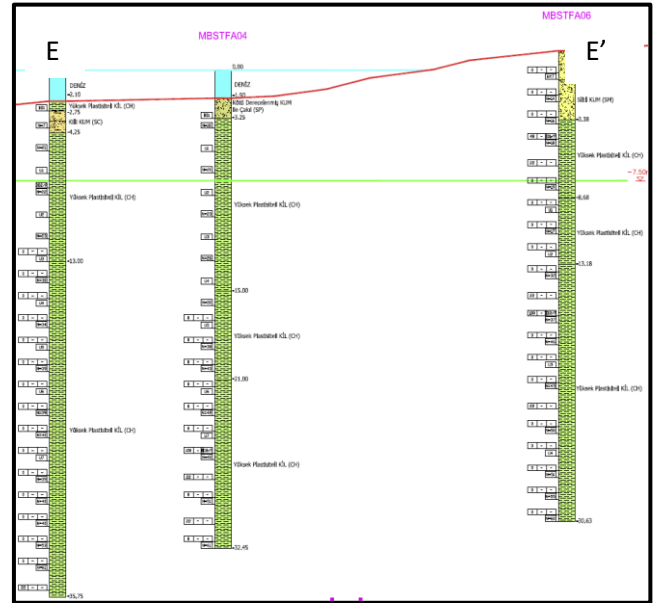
Kuru havuz çalışma alanı sondaj planı [7]
